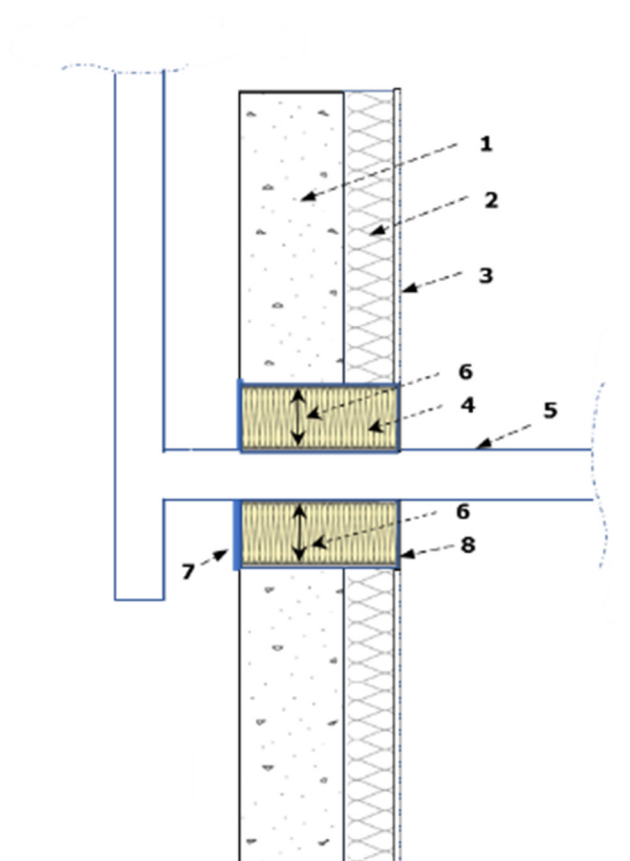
cas a, b et c : Traversée d'une paroi verticale extérieure : coupe verticale
